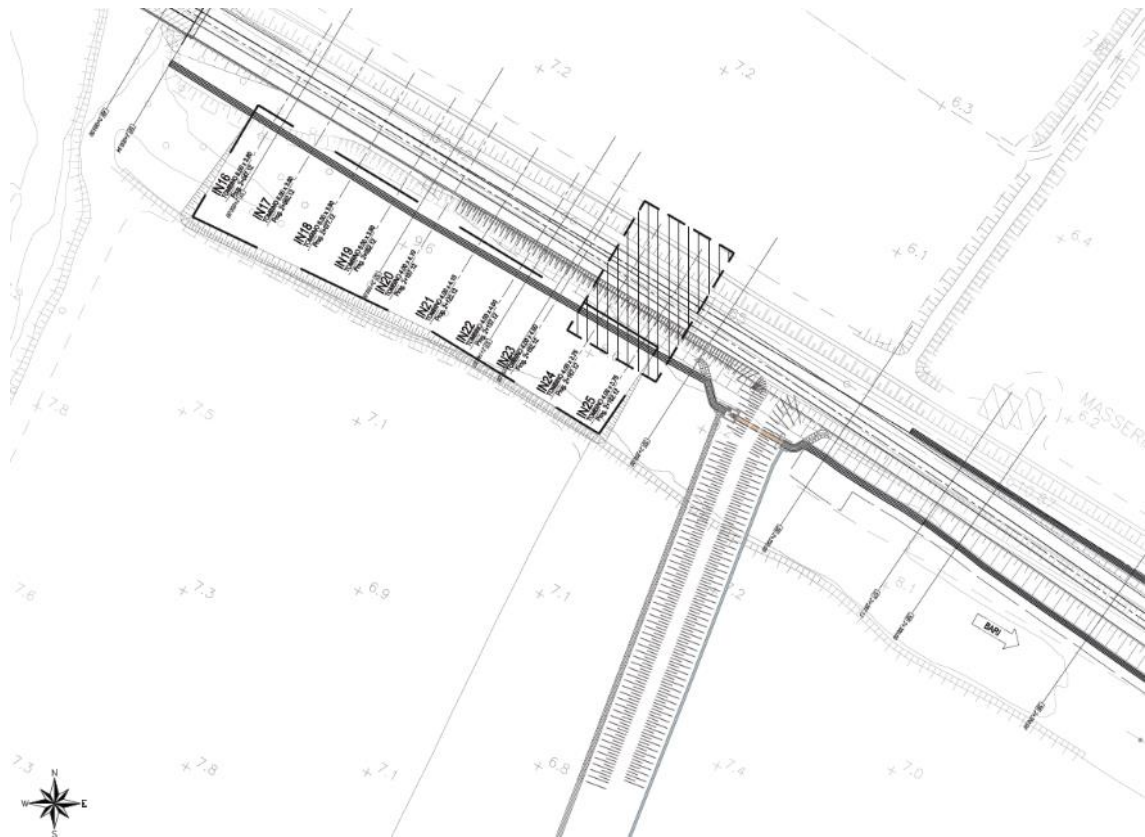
Scatolari in c.a. IN24 ed IN25 – Vista Planimetrica
